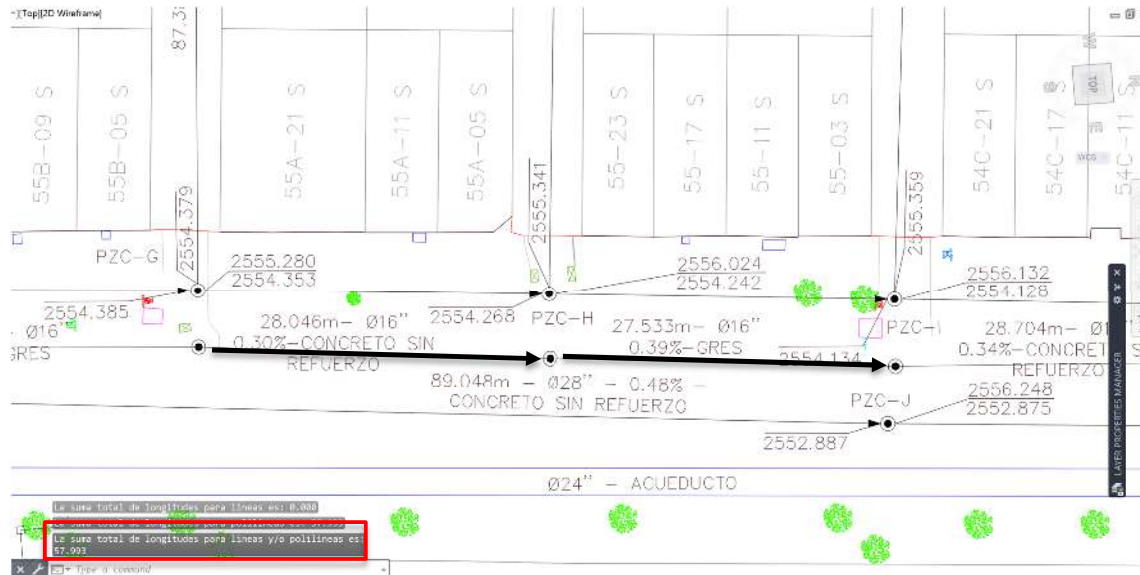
Cuantificación de longitud alcantarillado pluvial D500mm.
